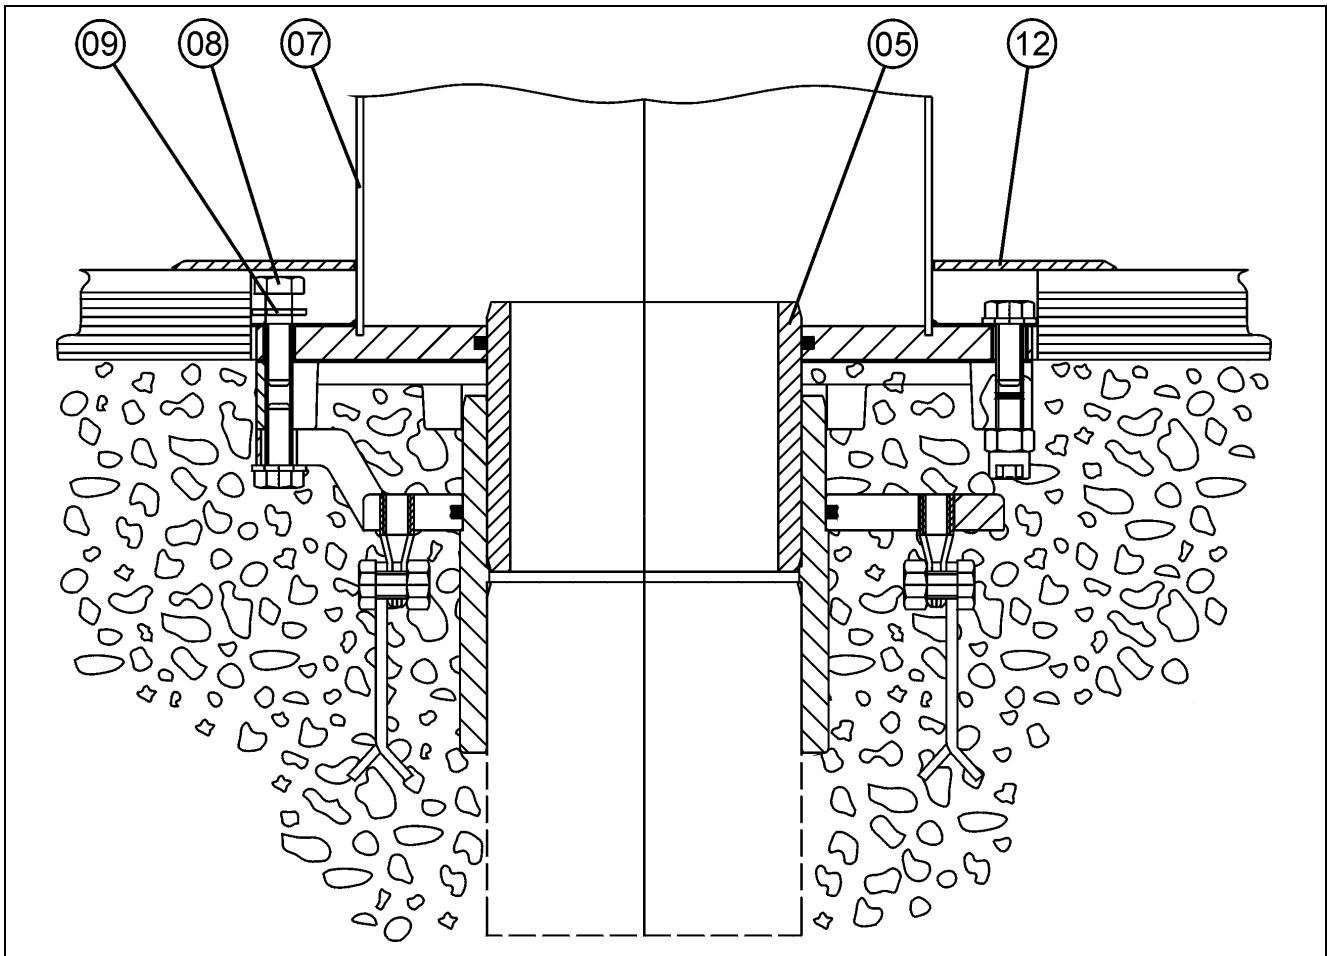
Betonbecken gefliest / Wasserzuführung senkrecht
